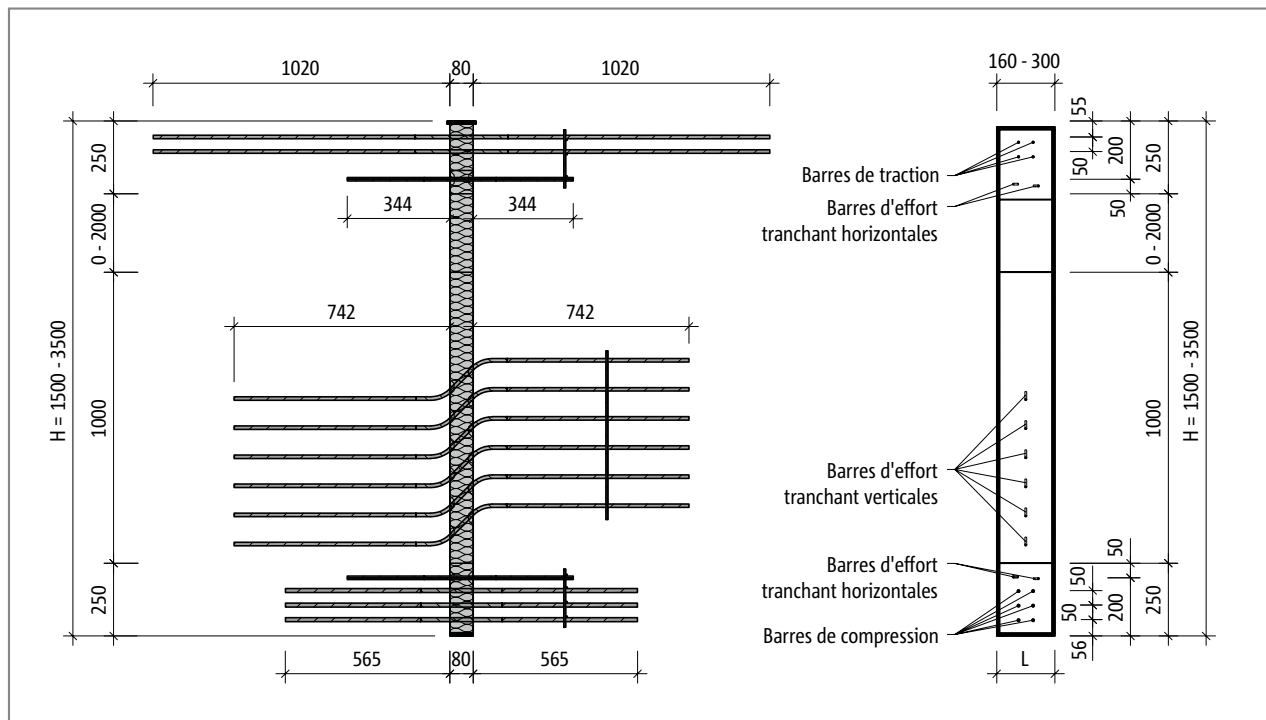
Schöck Isokorb® T Type W-M4 : Coupe et vue du produit
